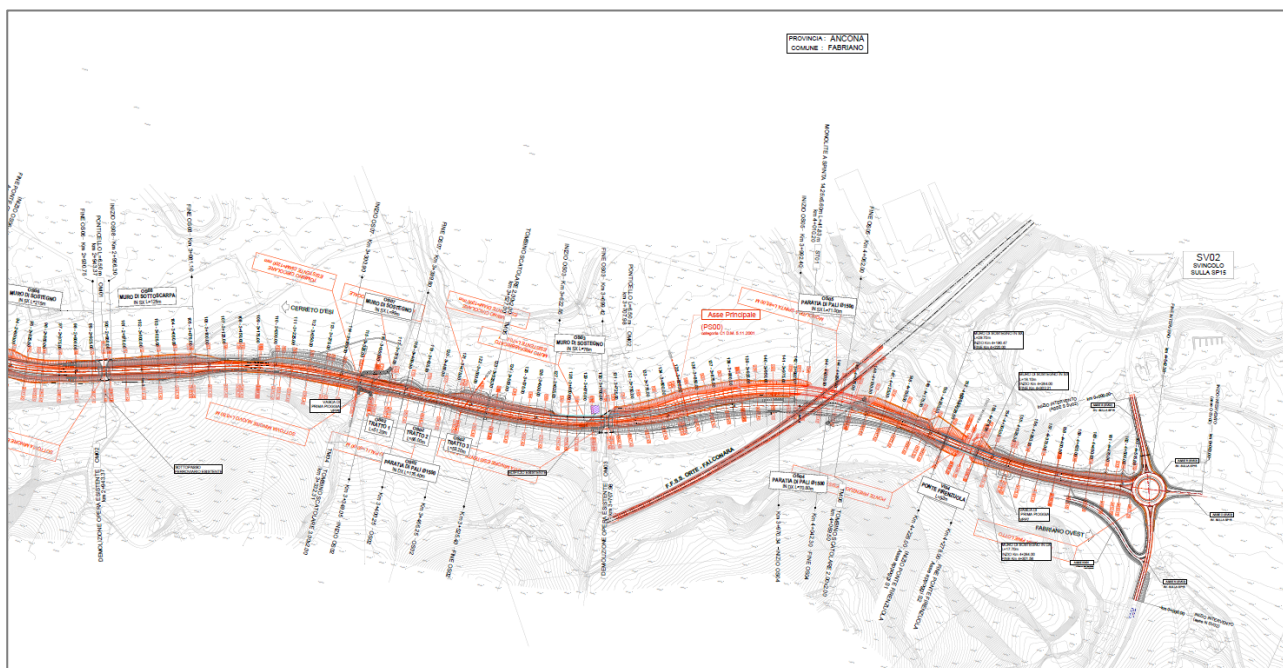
Planimetria di sovrapposizione del progetto definitivo al progetto preliminare - Tav. 3/3
